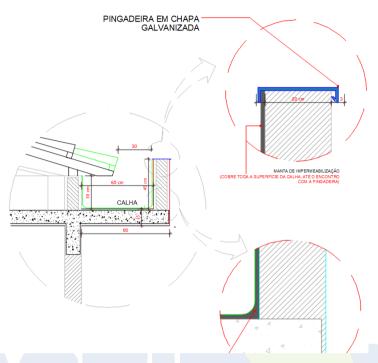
Detalhe do posicionamento da calha gal<mark>vanizada entre o</mark> telhado e a platibanda. Utilizar adesivo PU nas emendas.
